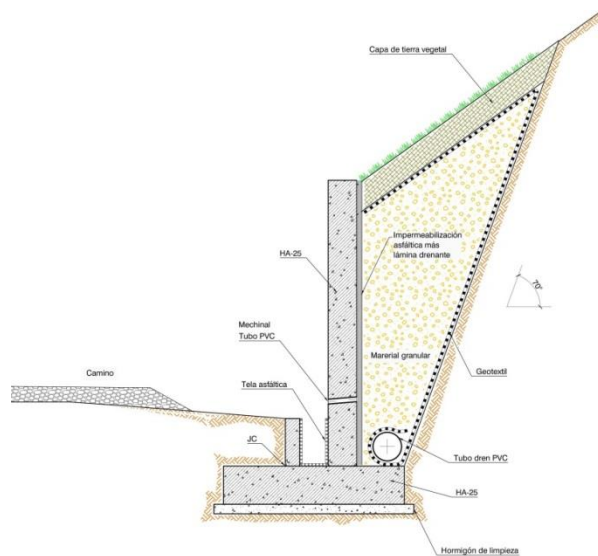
Detalles de drenaje e impermeabilización en trasdós de muros. En pasos inferiores, no habría cuneta interior Fuente: Elaboración propia
